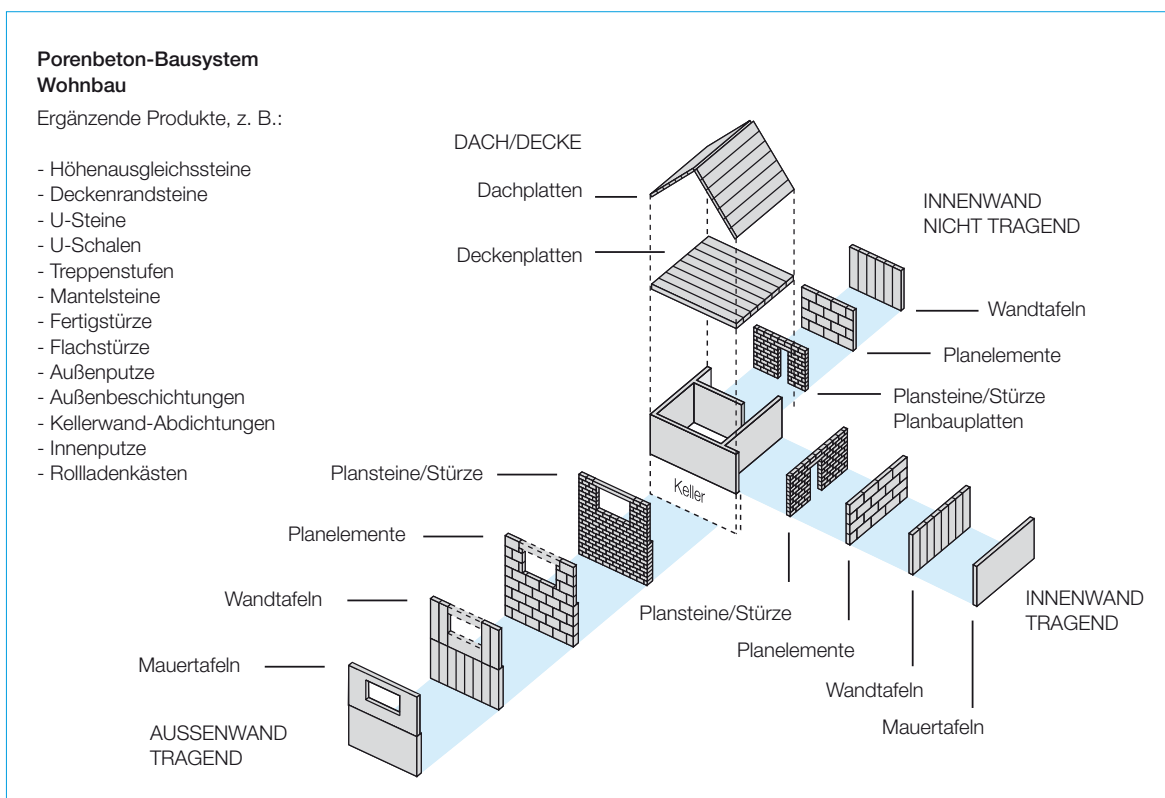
Porenbeton-Bausystem „Wohnbau“
